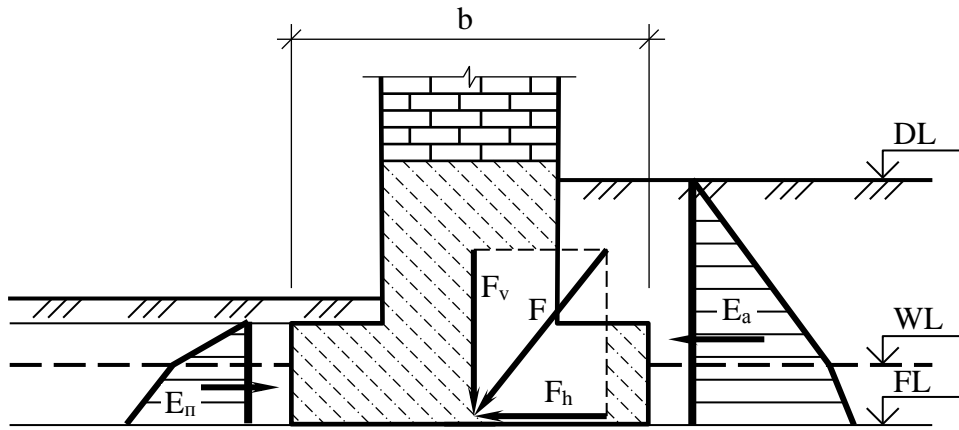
До розрахунку фундаменту на плоске зрушення
